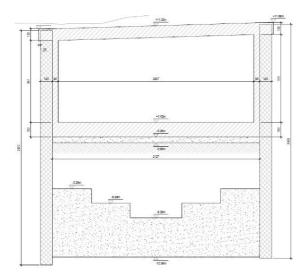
Sezione GA Fornaci II – Sezione tipo a una canna
